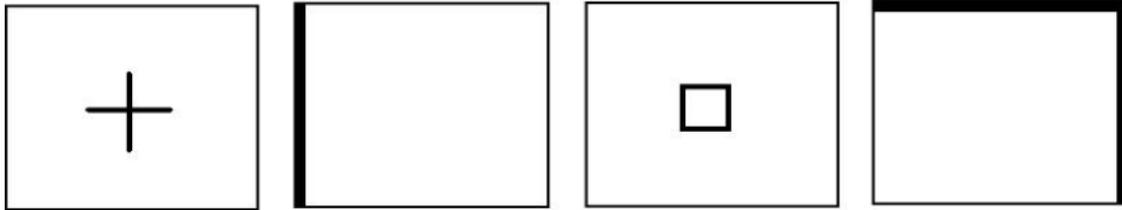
Formas de disposición de los muros en planta con escasa rigidez torsional
